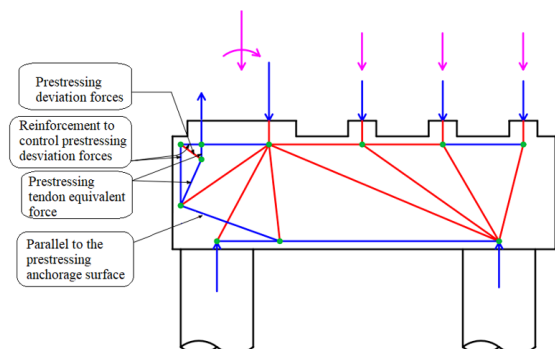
Modelo de bielas y tirantes para el diseño de la armadura de la cimentación conjunta de la pila 18, excéntrica, del puente 113B y la pila 2 del puente 504.
